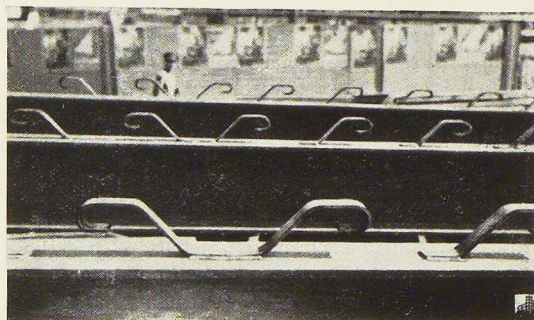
Lattes en acier soudées aux poutres du tablier pour solidariser la dalle en béton armé et les poutrelles.
